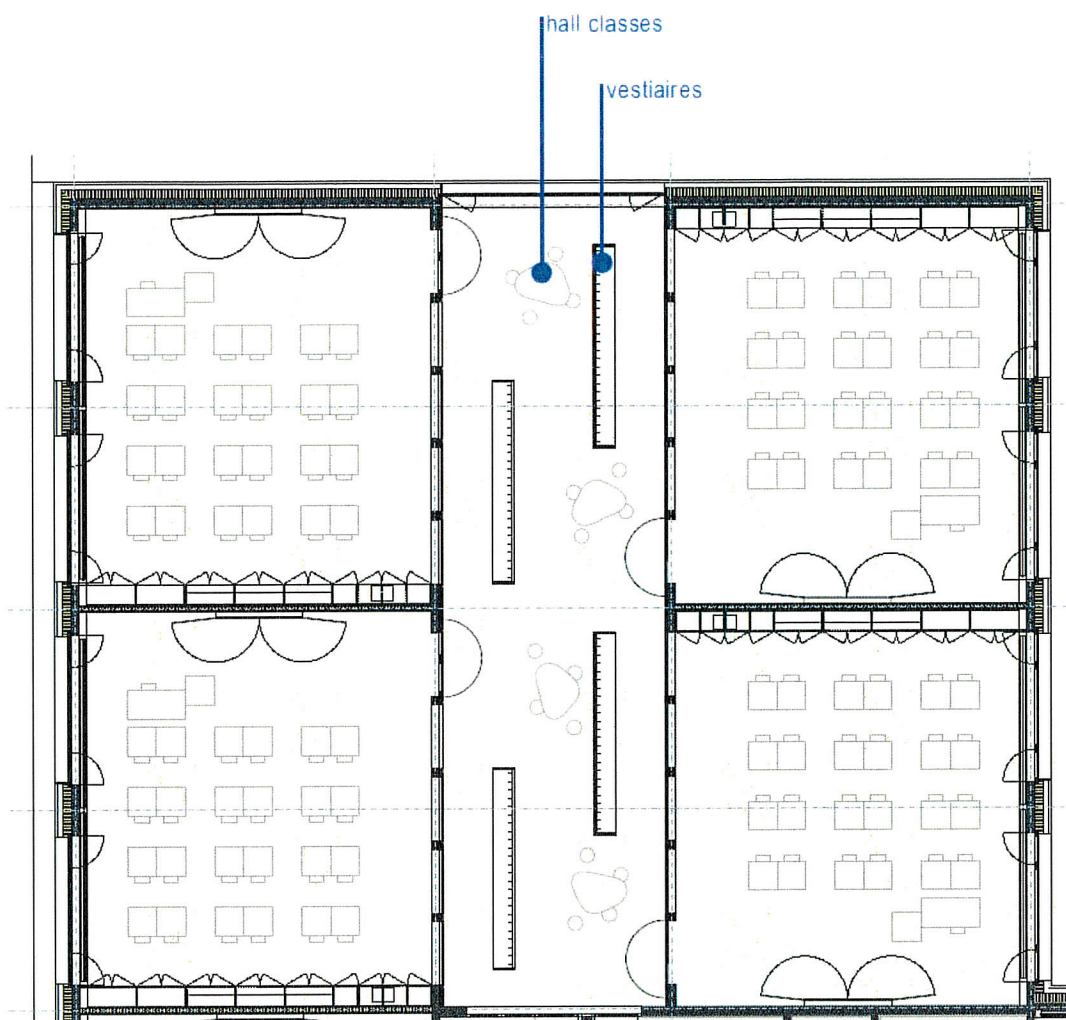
Groupe de 4 salles de classe et hall central, 1^{er} étage
